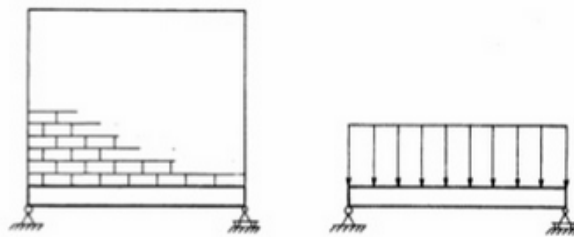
Parede sobre viga – ação usual (PARSEKIAN, 2013)
